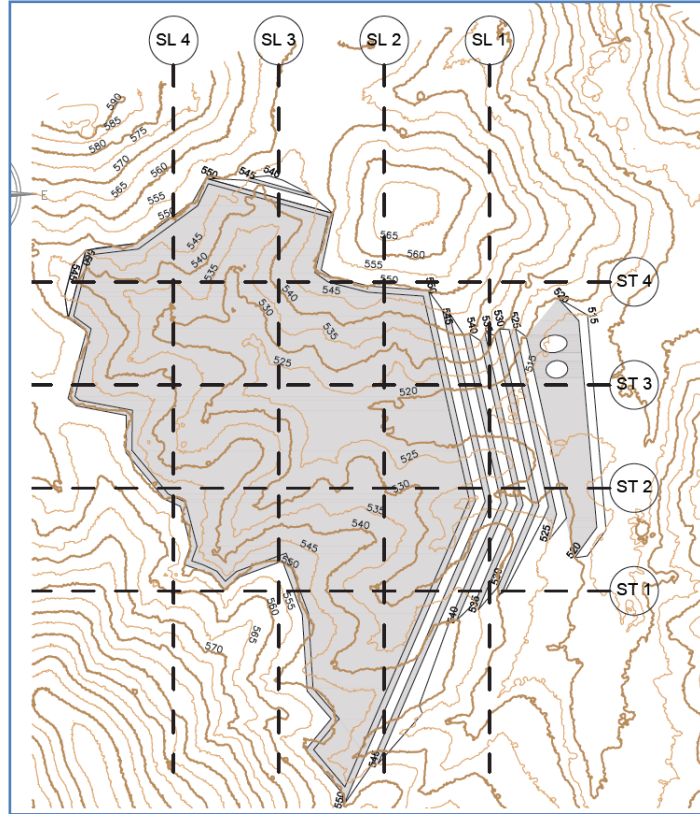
Planta con las secciones constructivas de proyecto.
